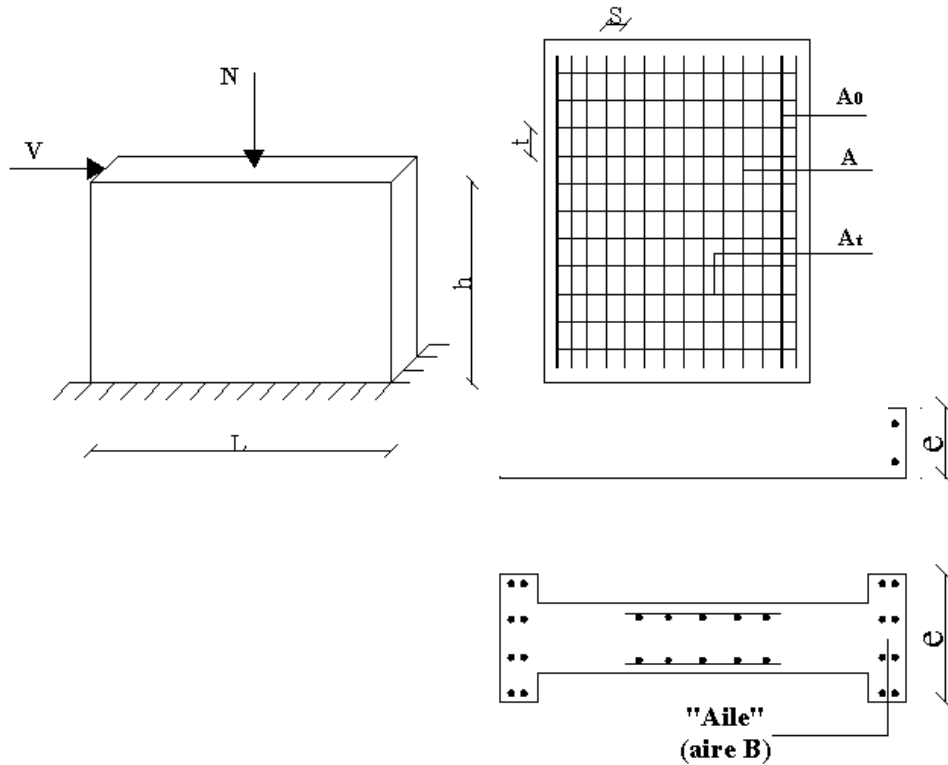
Schéma d'un voile plein et disposition du ferrailage
